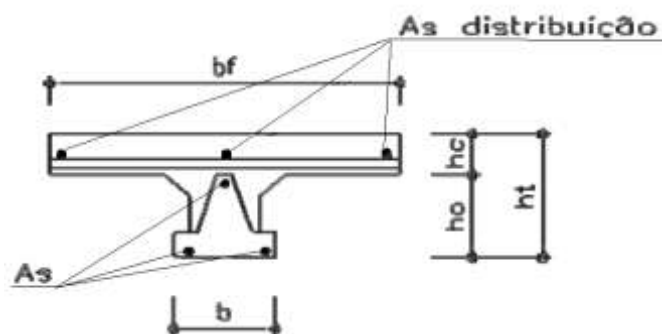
Seção típica de Viga T conforme pré-moldada.
